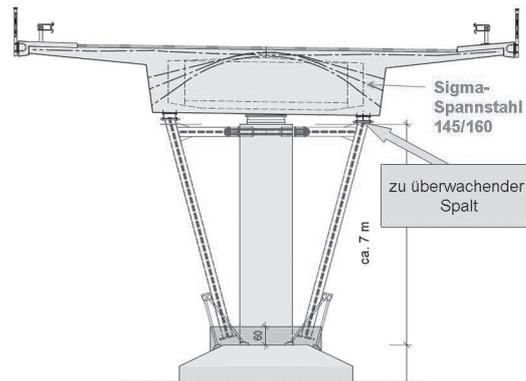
Abfangkonstruktion in Verbindung mit einem Monitoring-System (schematisch)
